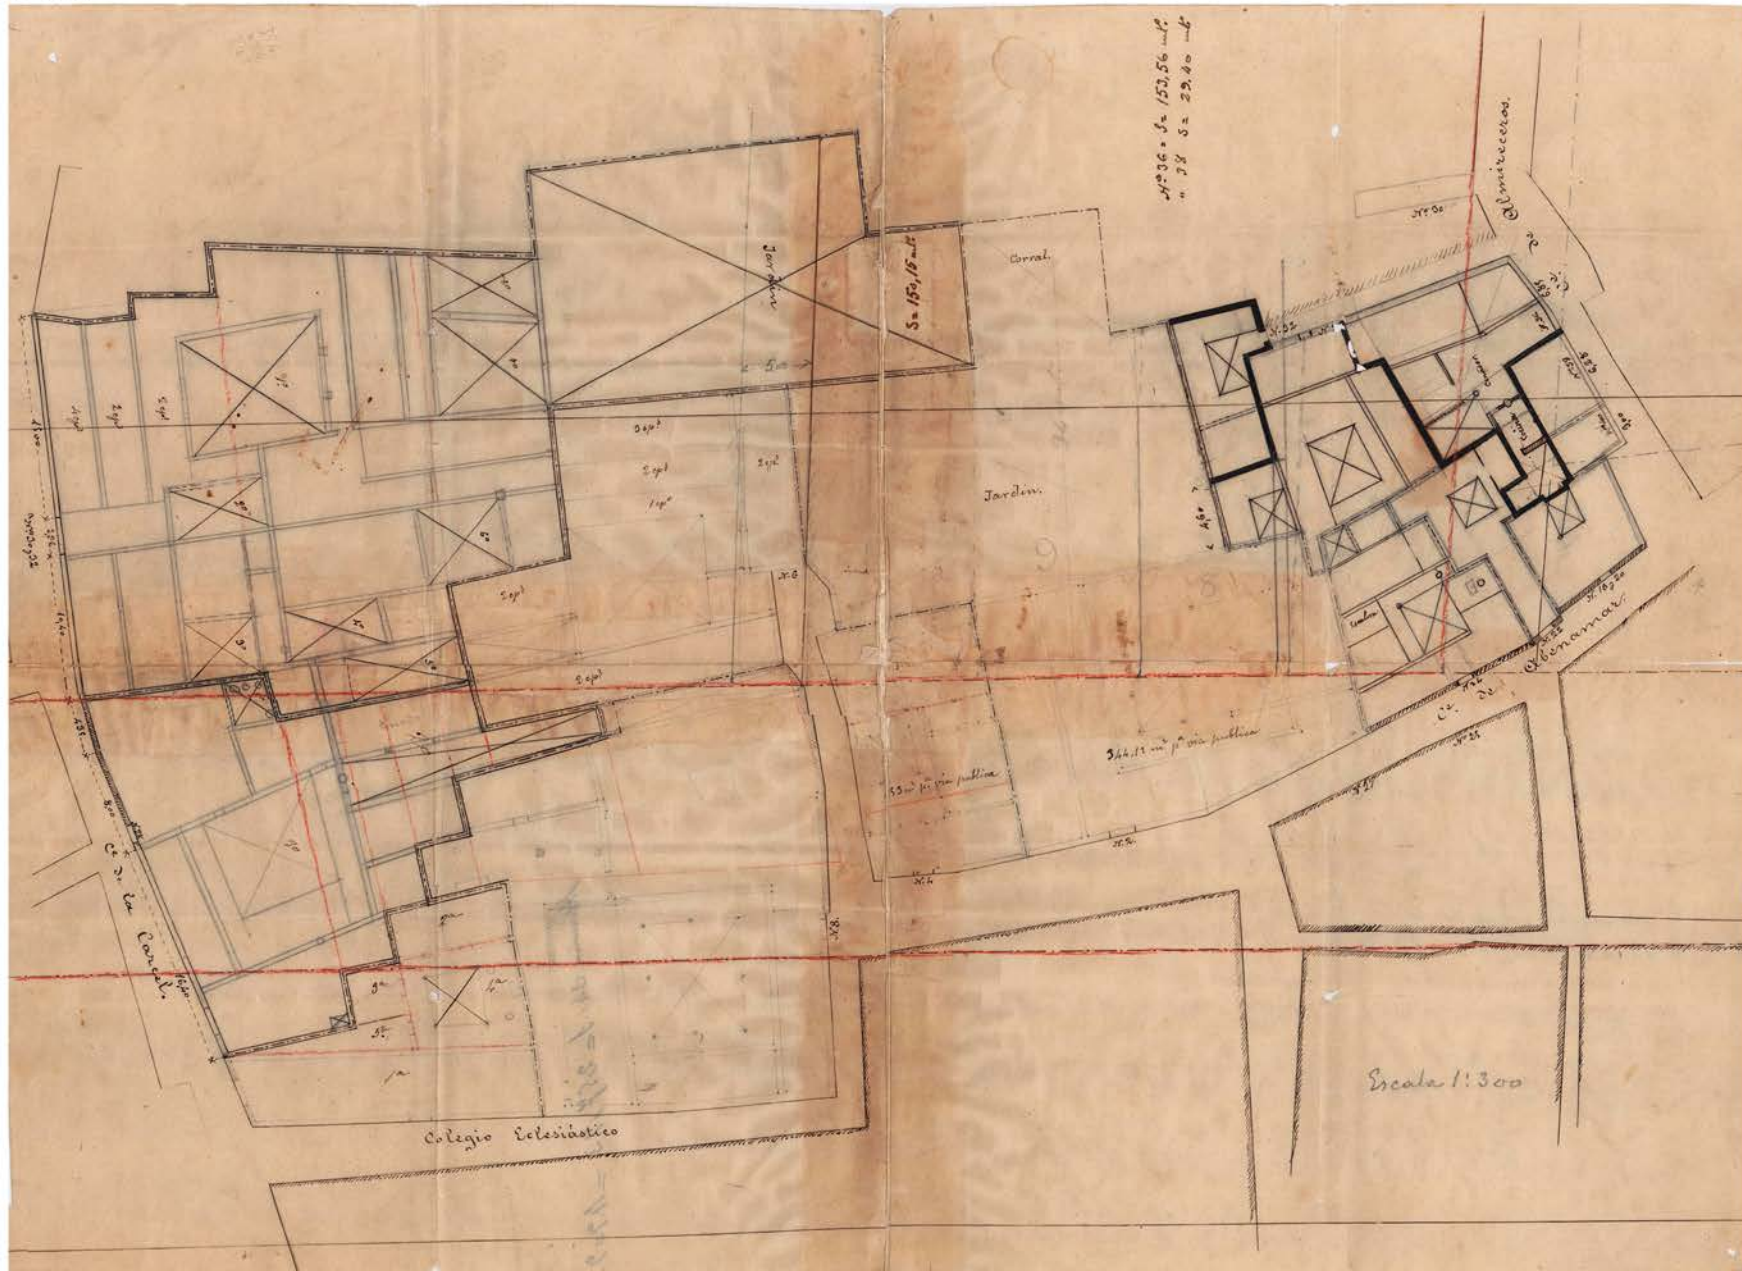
Plano de detalle del tramo entre la calle Almiceros y Cárcel Baja. (s.f., ASM).
